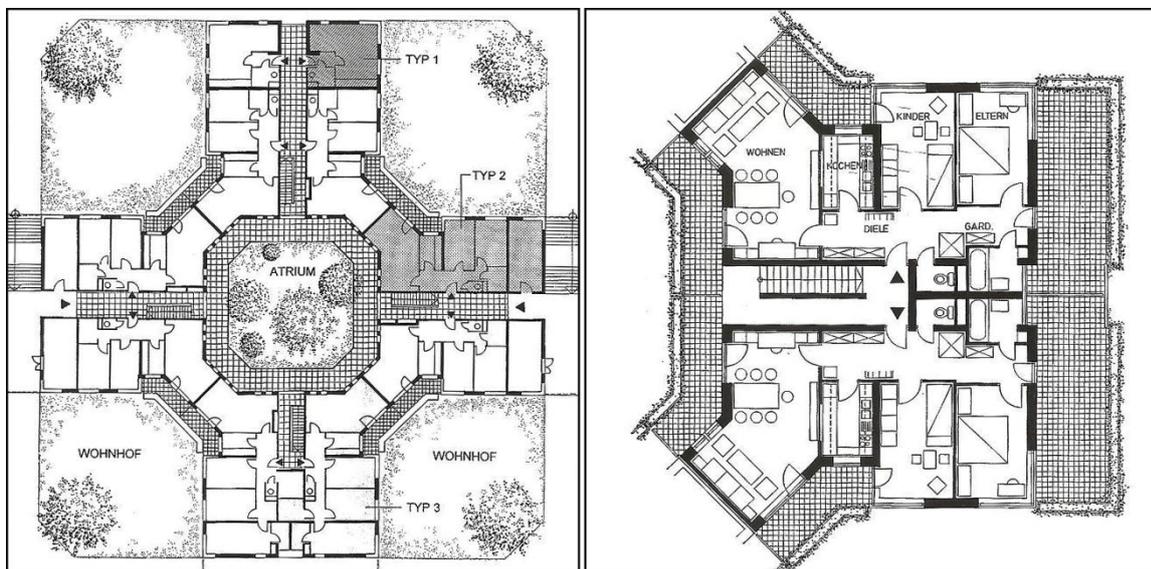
Grundrisstypen der Mehrfamilienhäuser. (Fotos: Hufnagl, Bauten – Projekte – Erfahrungen – Erkenntnisse – Gedanken – Theorie, S. 194f.)
